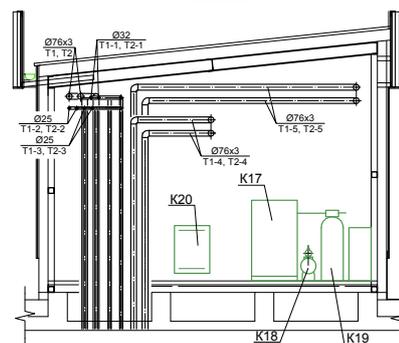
Розподілення навантажень по контурам: опалення, вентиляція, гаряче водоснабження
